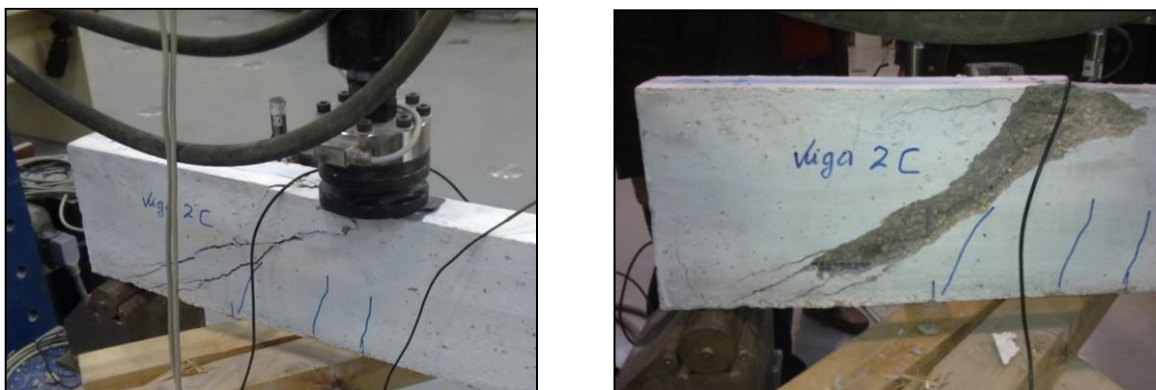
Fissuras de esforço transversal nas faces laterais da viga V2
